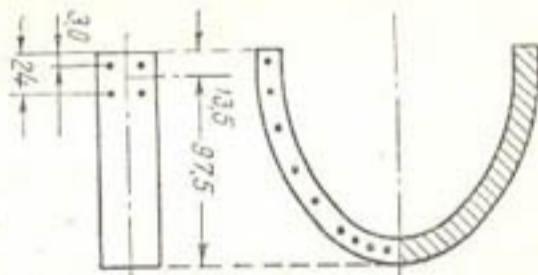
Поперечное сечение лотка со схемой расположения напряженной арматуры (к расчету на монтажную нагрузку).
